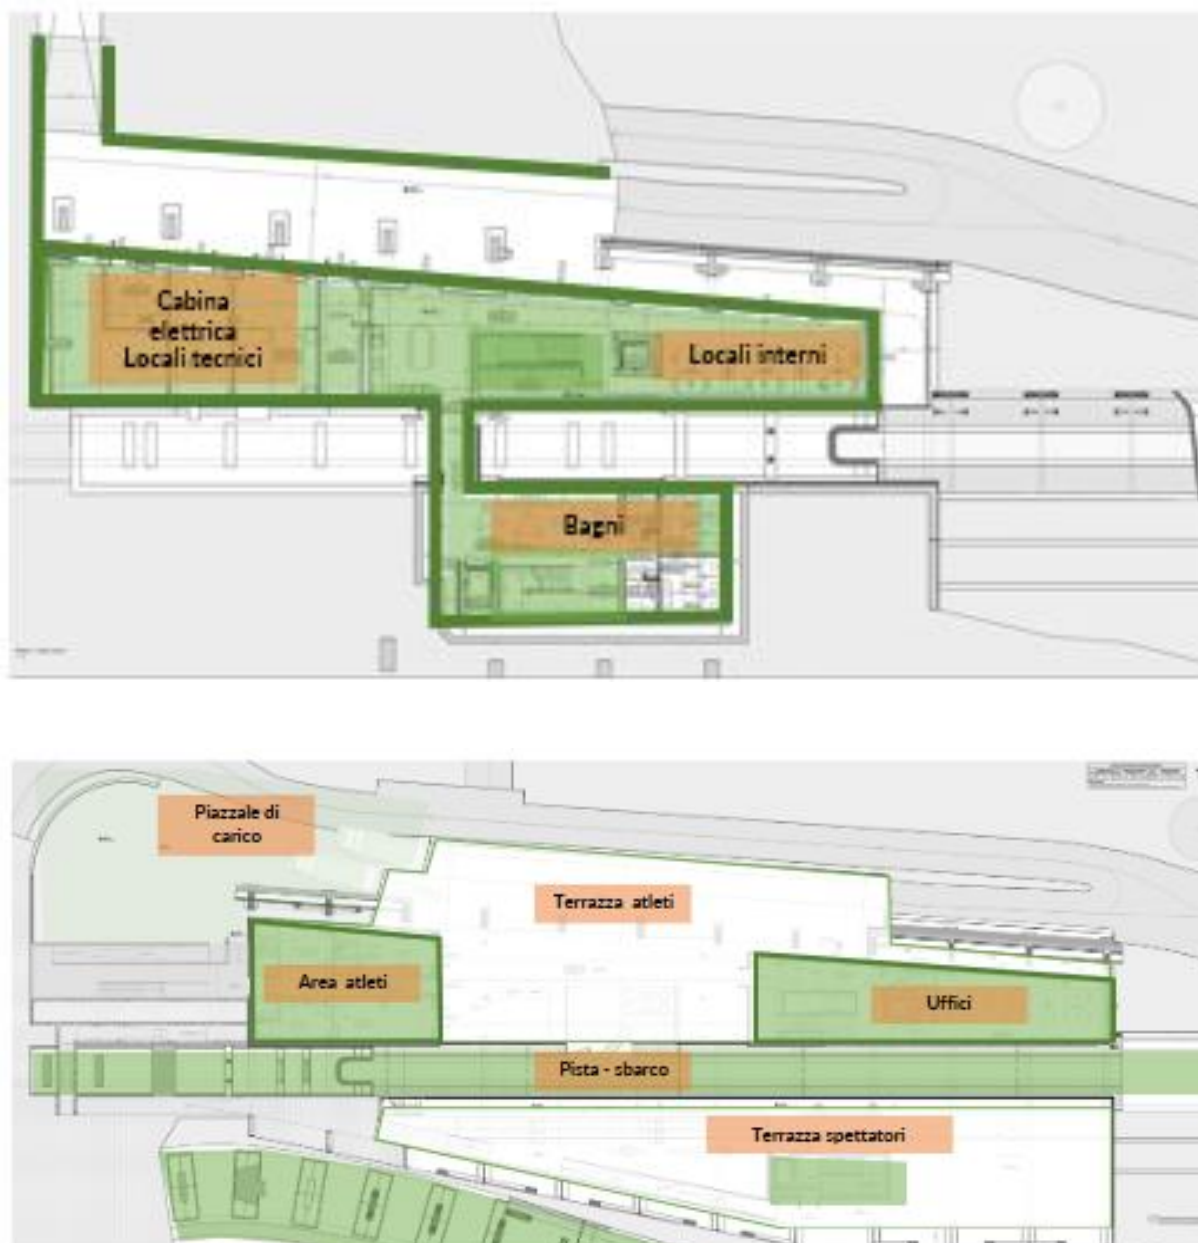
In alto pianta piano terra, in basso pianta piano primo (terrazza). In verde, le parti confermate nell'aggiornamento del progetto
